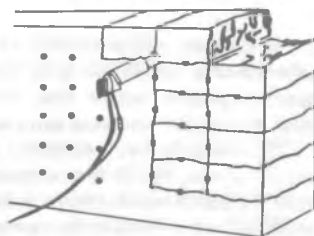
Применение гидравлического расклинивающего устройства для разрушения железобетонной стены
